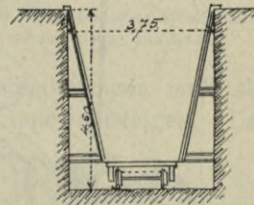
Querschnitt der Grube mit Plattformwagen ohne Kasten.
